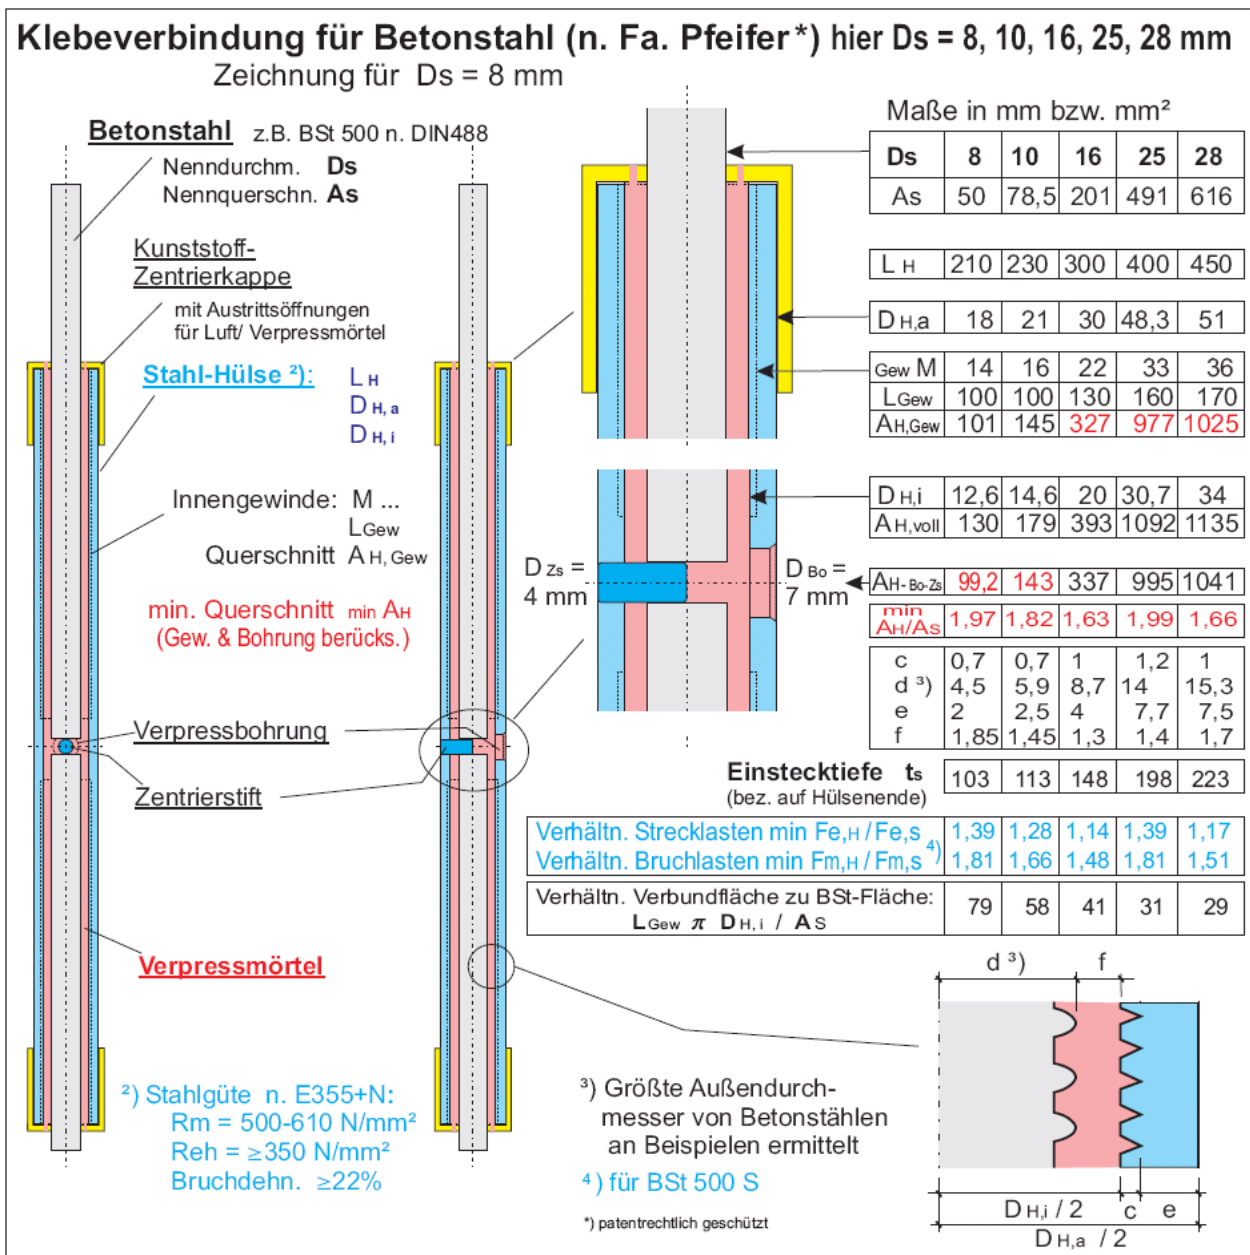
Prinzipskizze und Maße zur verwendeten Klebeverbindung von Betonstäben.
